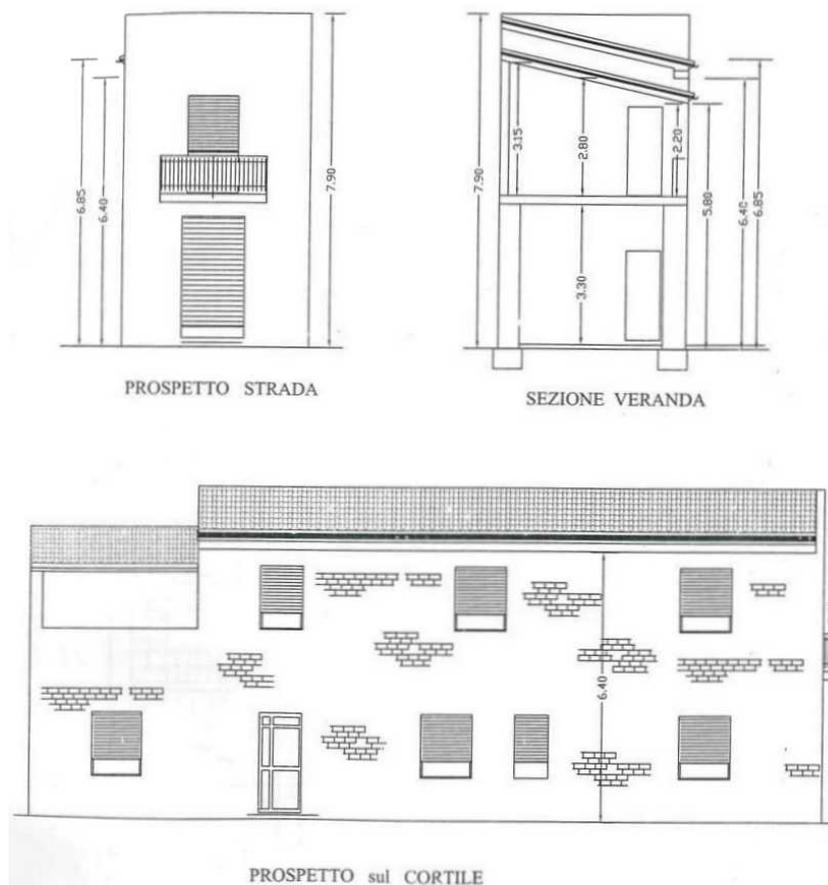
Accertamento conformità del 13/05/2011 – Prospetti e sezione prima dell'intervento
